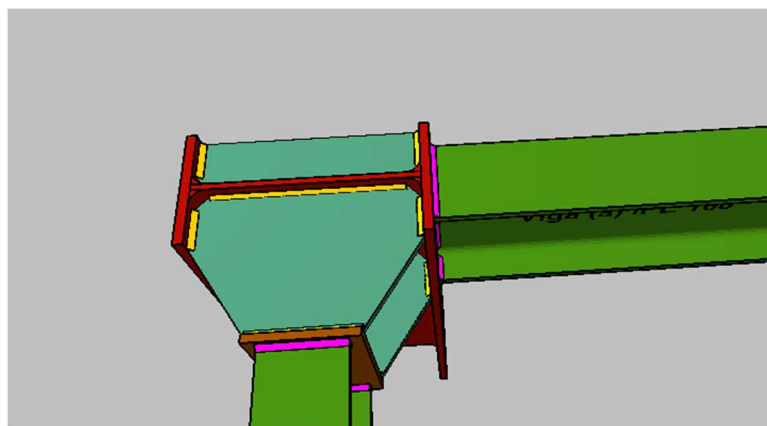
UNIÓN SOLDADA 2. FUENTE : CYPE 3D
